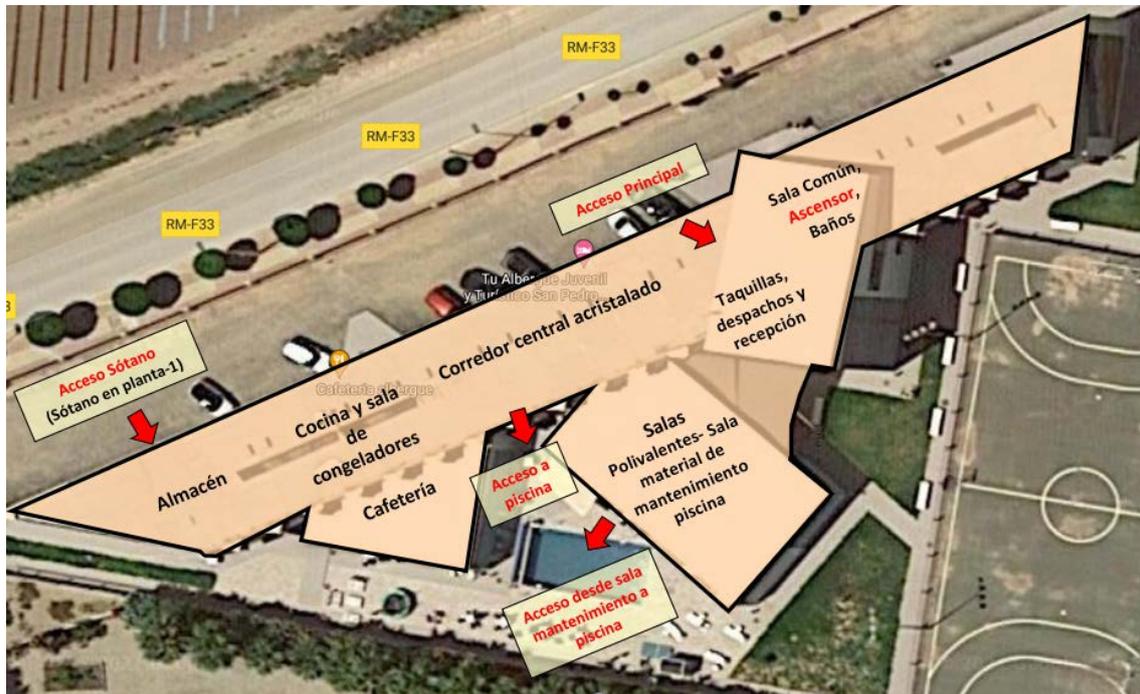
Croquis de distribución de la zona afectada en planta baja y sótano
